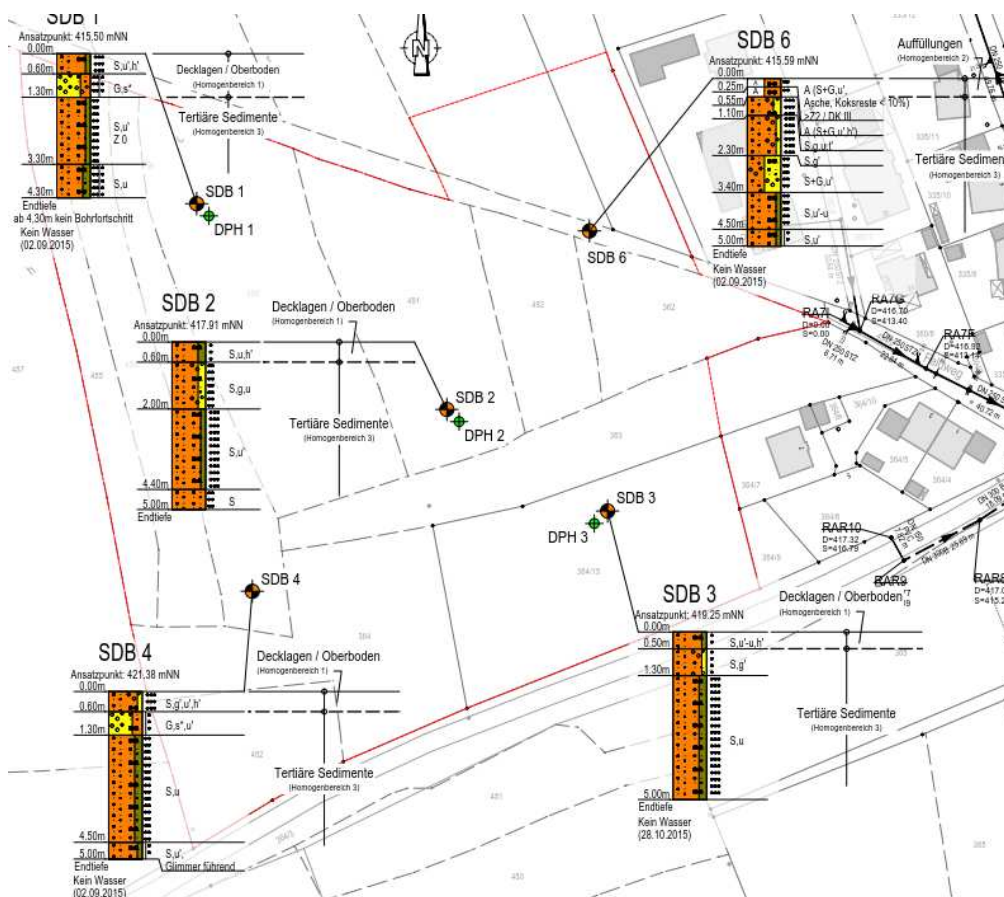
Lageplan mit Aufschlusspunkten und Bohrprofilen, Baugrundgutachten Anlage 1
